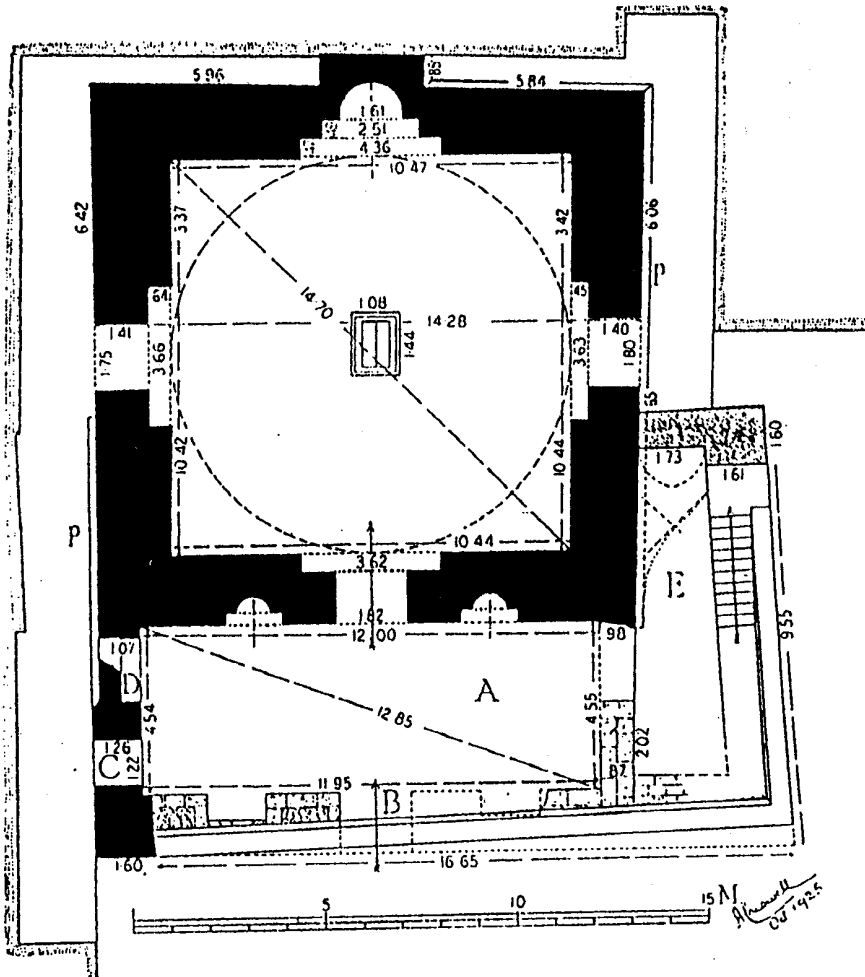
مسقط أفقي لجامع عذب قاضي (باب العذب) في استانبول (عن Goodwin)
